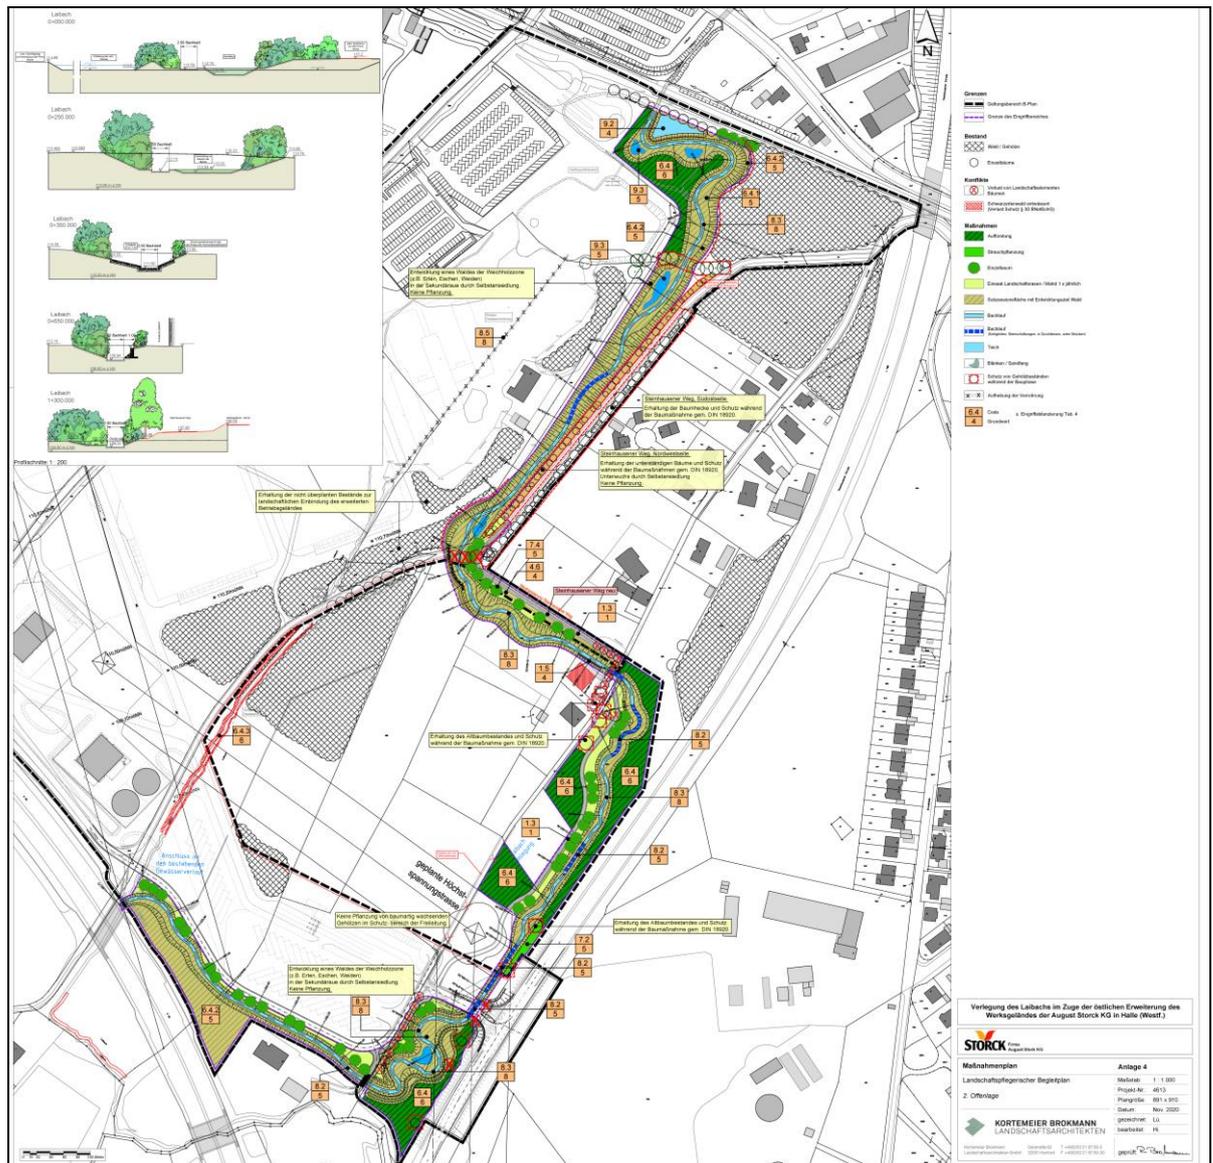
Verlegung des Laibachs im Zuge der östlichen Erweiterung des Firmengeländes der August Storck KG in Halle (Westf.), hier Maßnahmenplan – Landschaftspflegerischer Begleitplan
